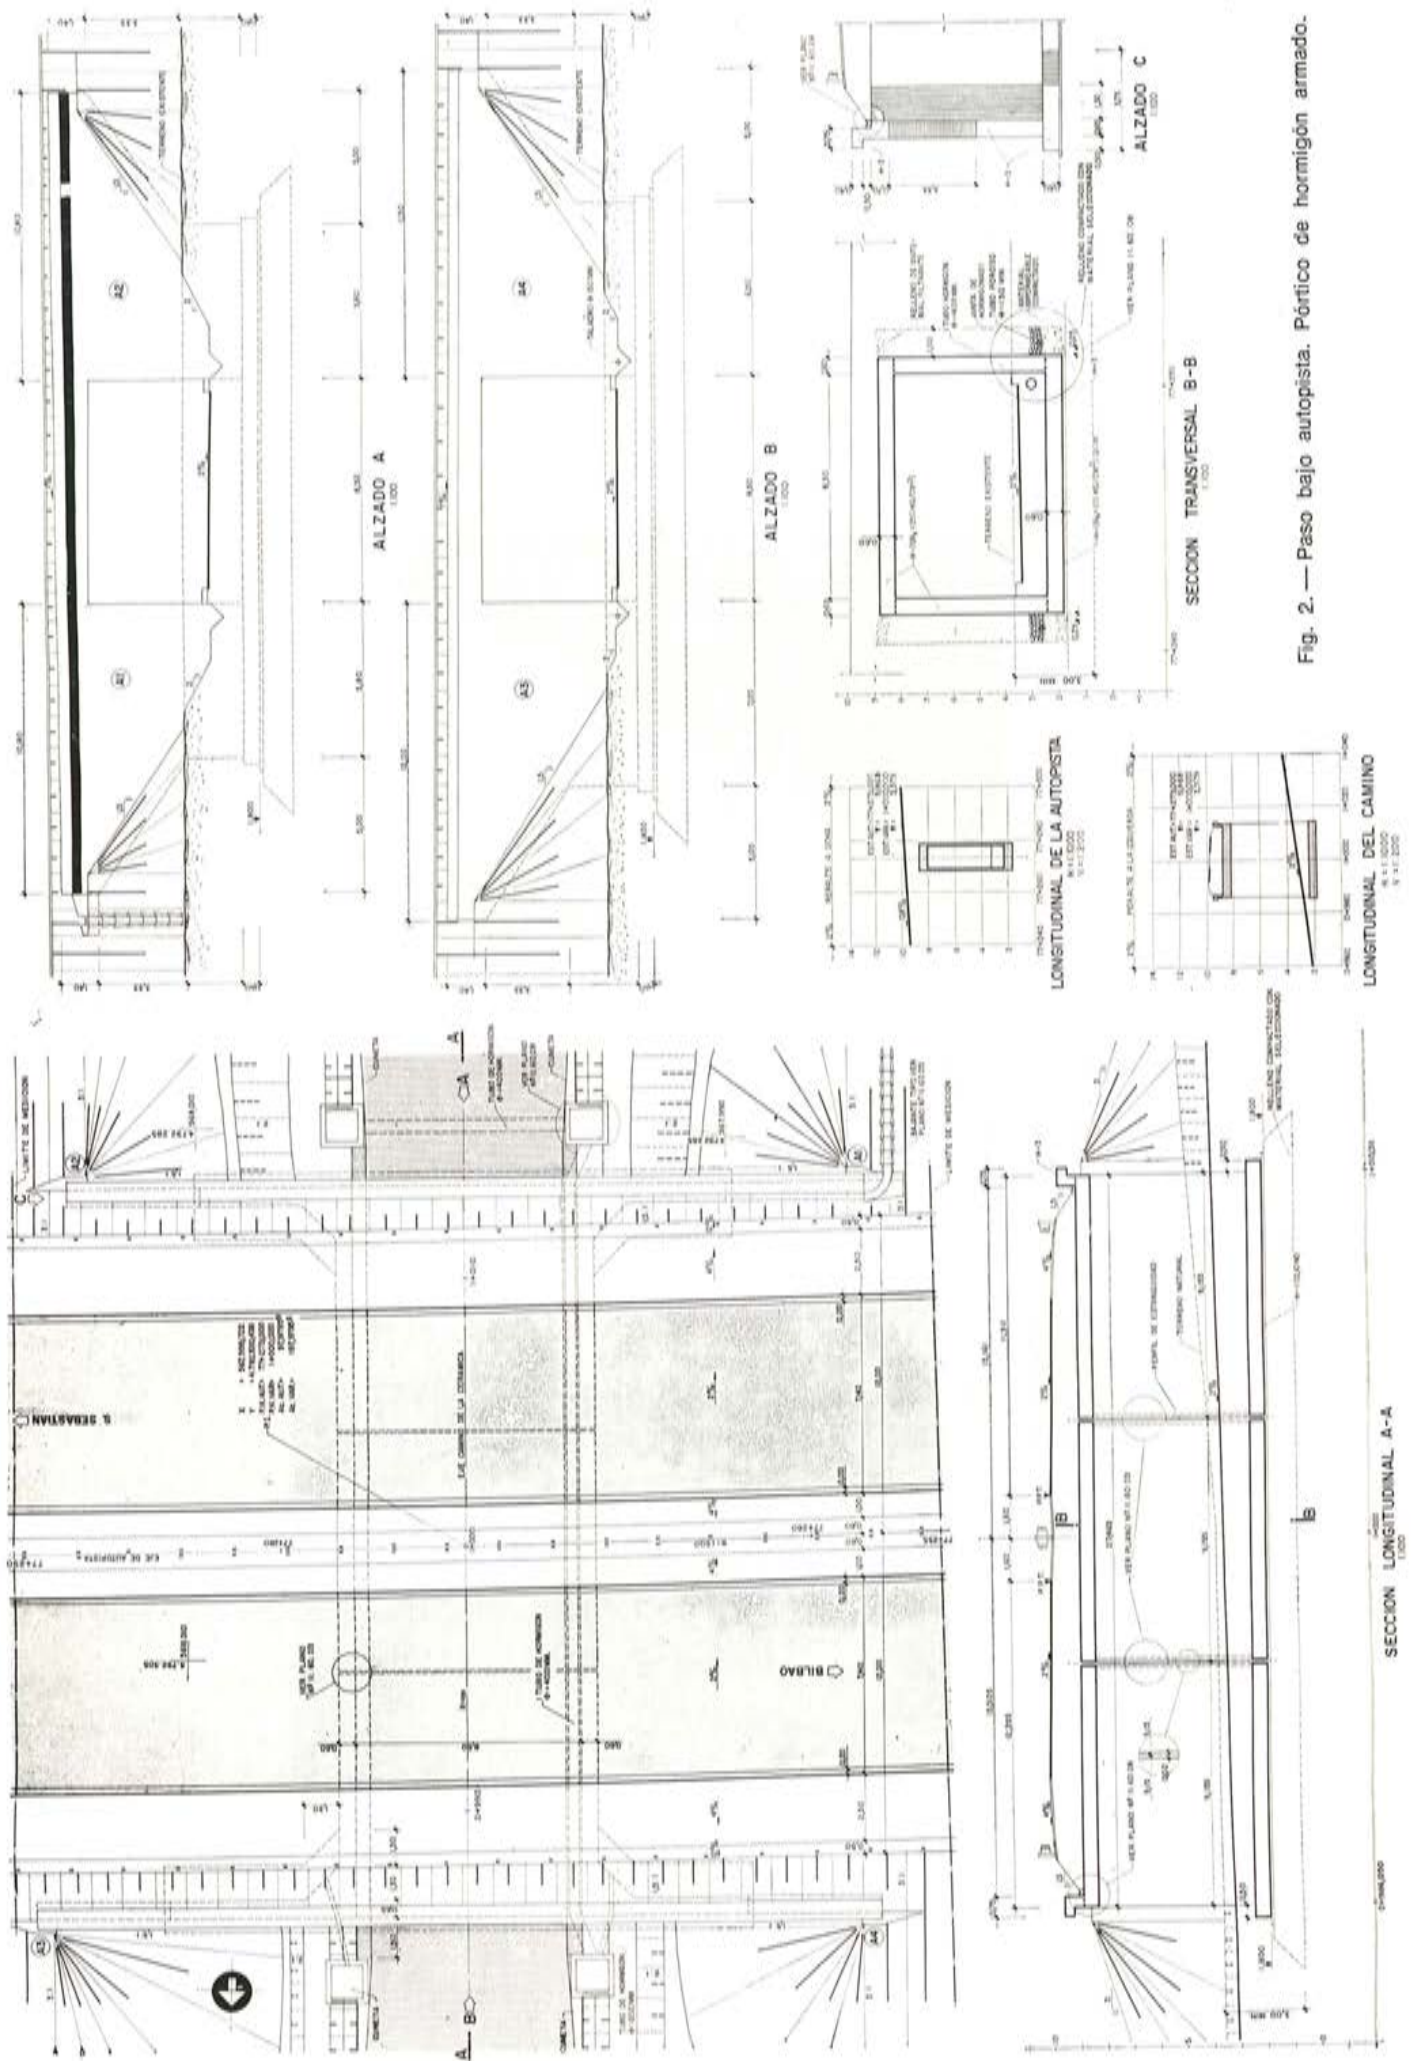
Paso bajo autopista. Pórtico de hormigón armado.
